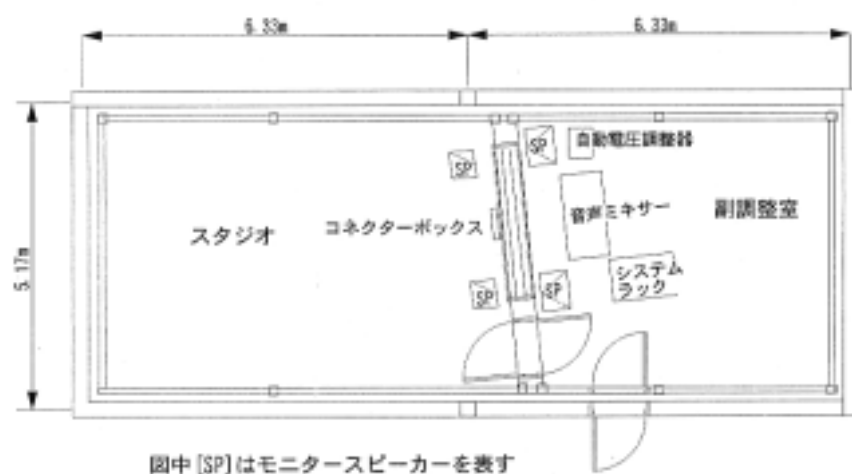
EMA 標準 ラジオスタジオ機器配置図
